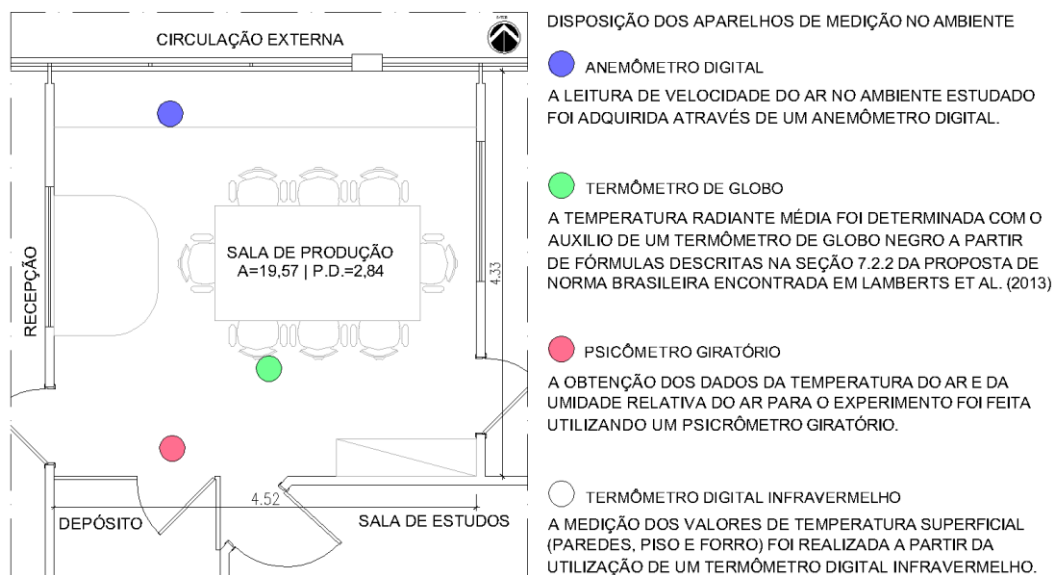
Planta baixa do ambiente com o posicionamento dos aparelhos de medição.
